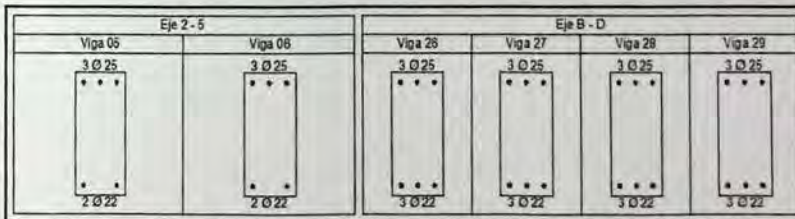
Distribución de refuerzo a flexión en vigas, ejes principales de estructura IV (Nivel 1-3).
